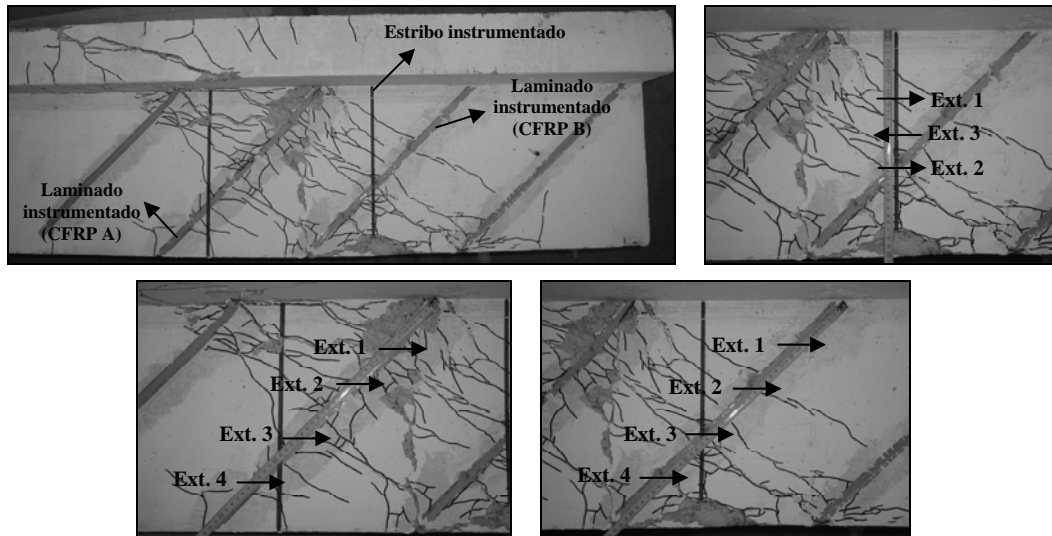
Localização dos extensómetros no laminado e estribo instrumentados da viga 2S-4LI45-C.
